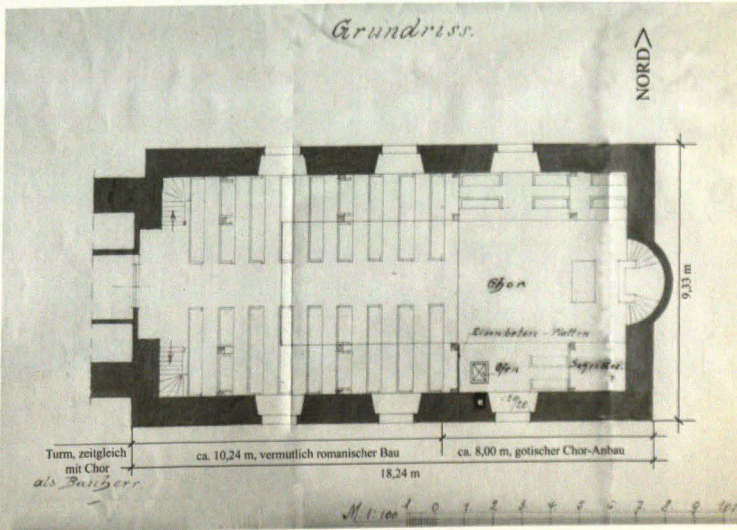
Kirche Wendhausen, Grundriss Heizungseinbau 1913. LAW, OA Wendhausen 11, mit neuen Eintragungen. Die Situation entspricht im Wesentlichen der von 1826.
